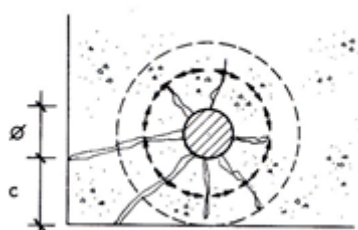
Fendilhação longitudinal do betão provocada pelas tensões radiais provenientes das nervuras de um varão isolado num canto (D'Arga e Lima, 2011)
